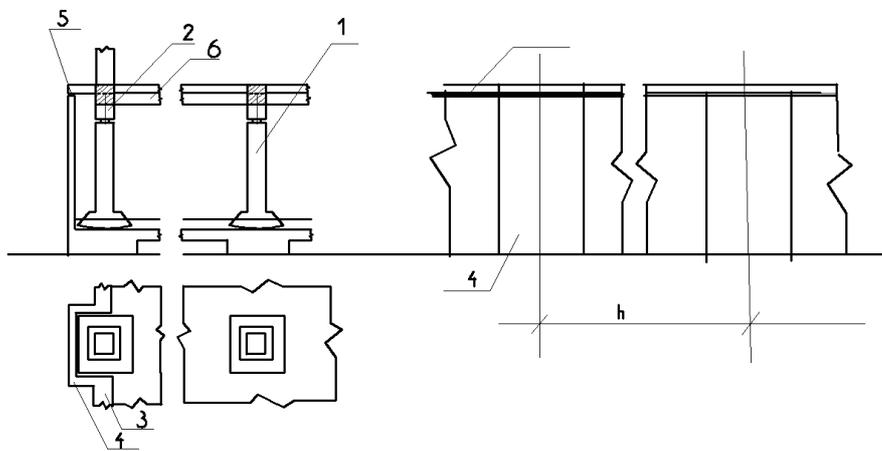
Конструктивная схема подвального этажа здания : 1-КФ-стойка; 2- оголовник (можно и без него); 3- основная ограждающая стена, если это подвальное помещение, или может быть остекление, если КФ на первом этаж; 4- ограждение КФ от боковой засыпки грунтом; 5- плотная прослойка, исключая залипание при смещении КФ (это связано с незначительным подъёмом); 6-балка перекрытия с монолитной плитой перекрытия (при сборном варианте узел несколько корректируется); h-расстояние между КФ-стойками.
